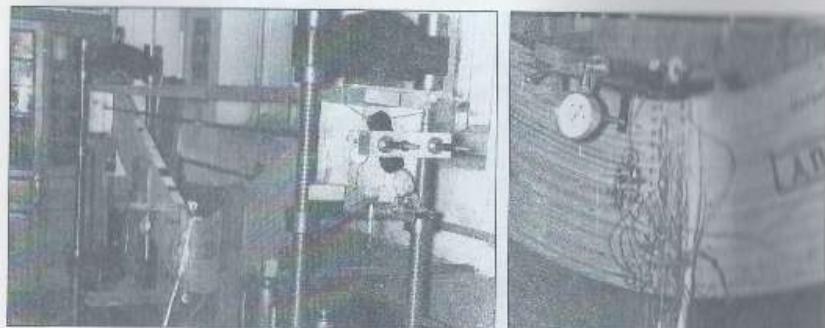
Испытание гнуто-клёсных балок на семиптимельном прессе ЛИСИ. Общий вид и фрагмент
